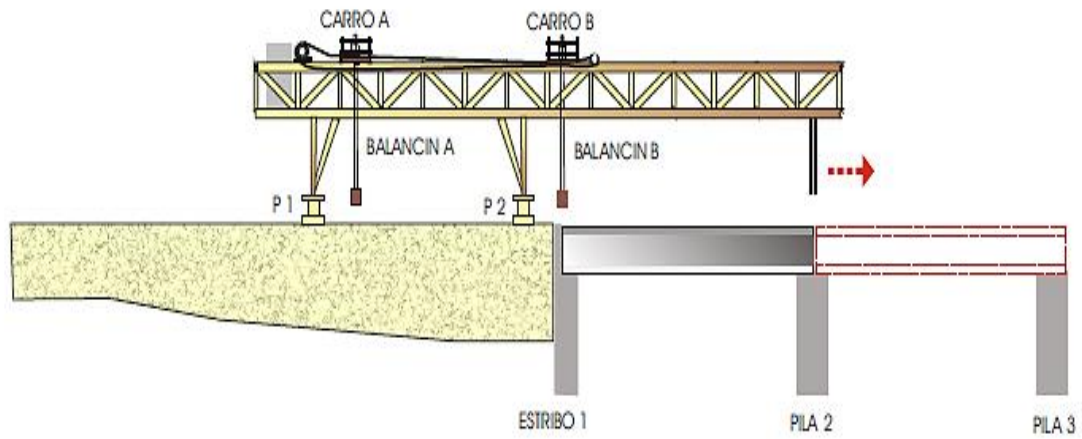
“FASE 5.- “Terminado con el número total de traveses, claros y colado de la losa de superestructura se traslada el dispositivo al siguiente claro y se repiten las secciones de trabajo”7
